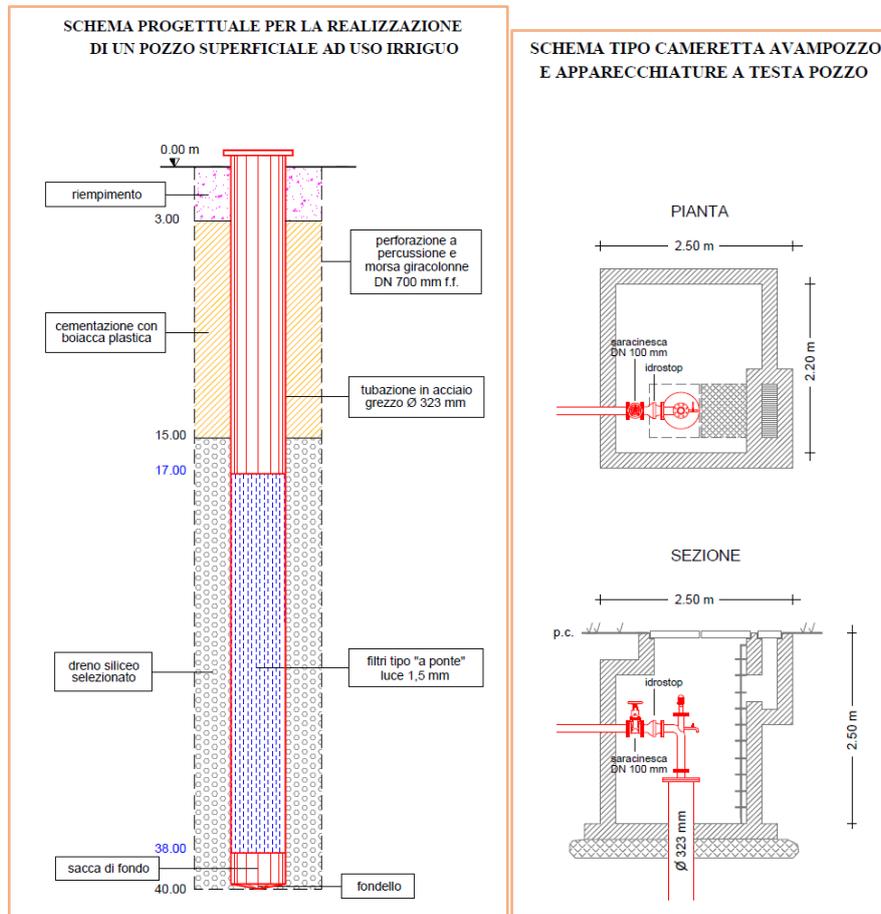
Schema progettuale, cameretta avampo e apparecchiature
